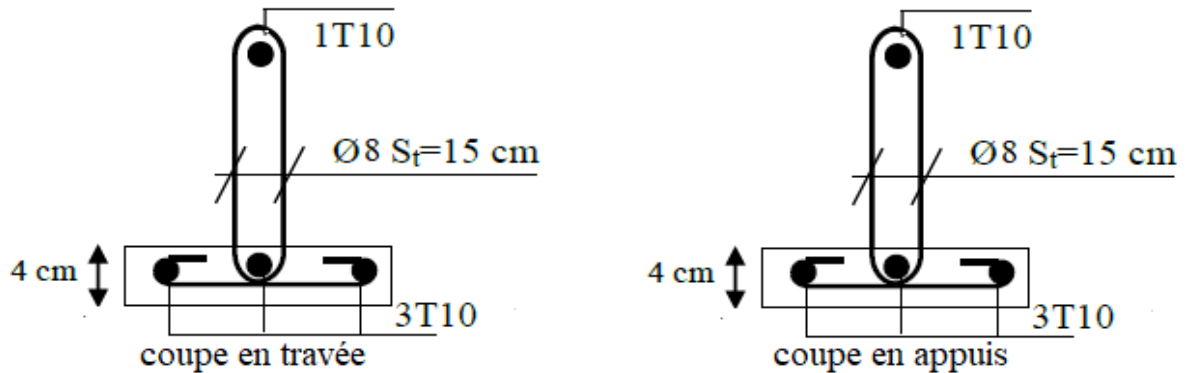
Schéma de ferrailage des poutrelles de rives RDC, étages courant
